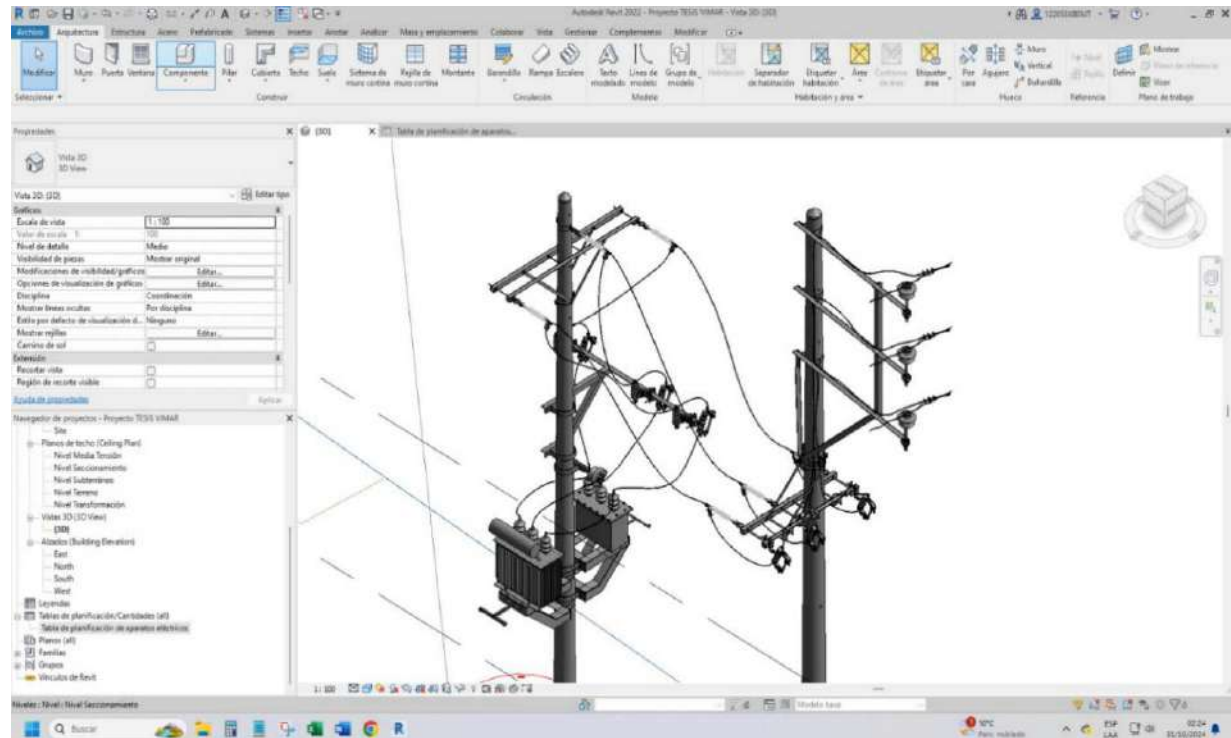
Ubicación de estructuras en planimetría de Red Primaria
